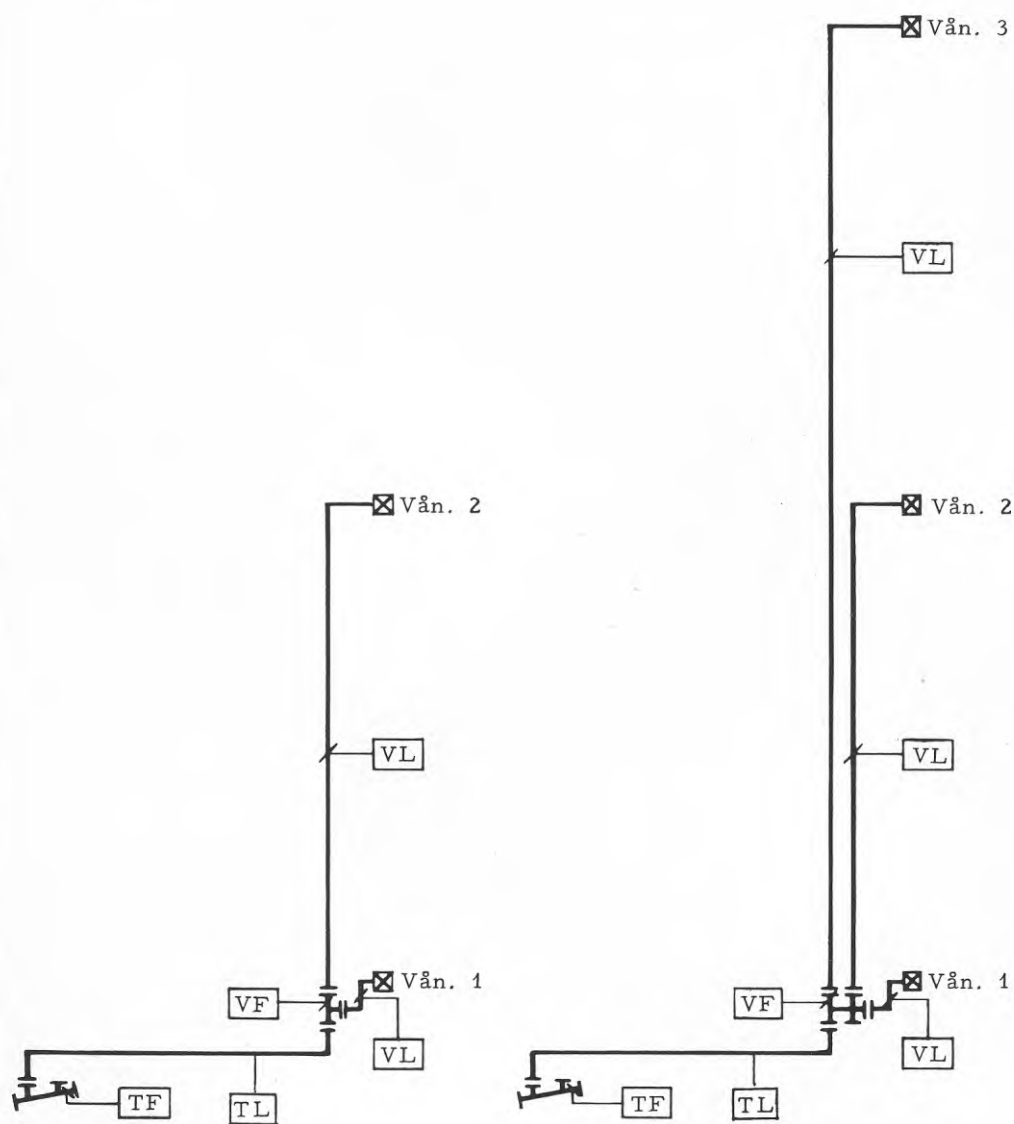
GRUNDKONSTRUKTIONENS DEL 1
